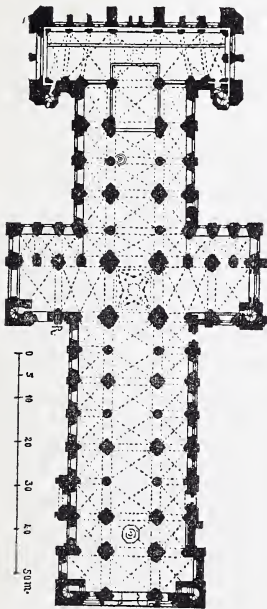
Grundriss der Kathedrale von Durham.
